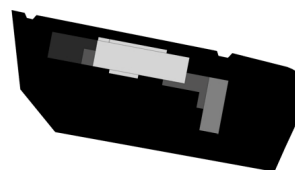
Esquema da planta de implantação da Escola Secundária Dr. Solano de Abreu, em Abrantes.
